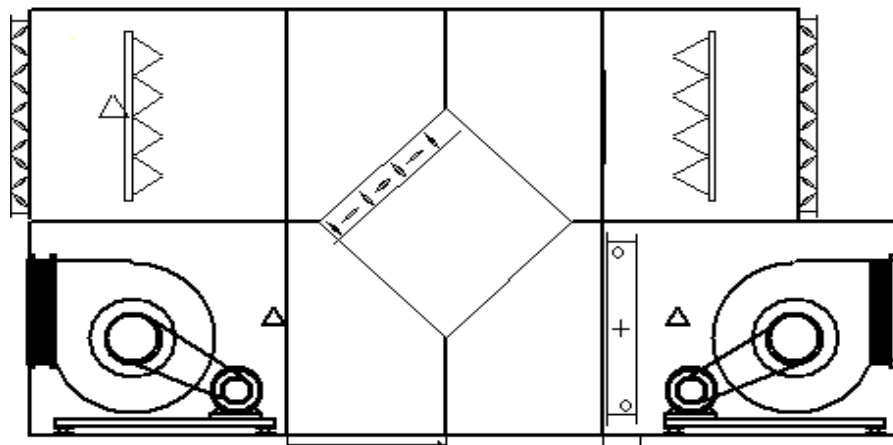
Приточно-вытяжная установка с пластинчатым рекуператором
